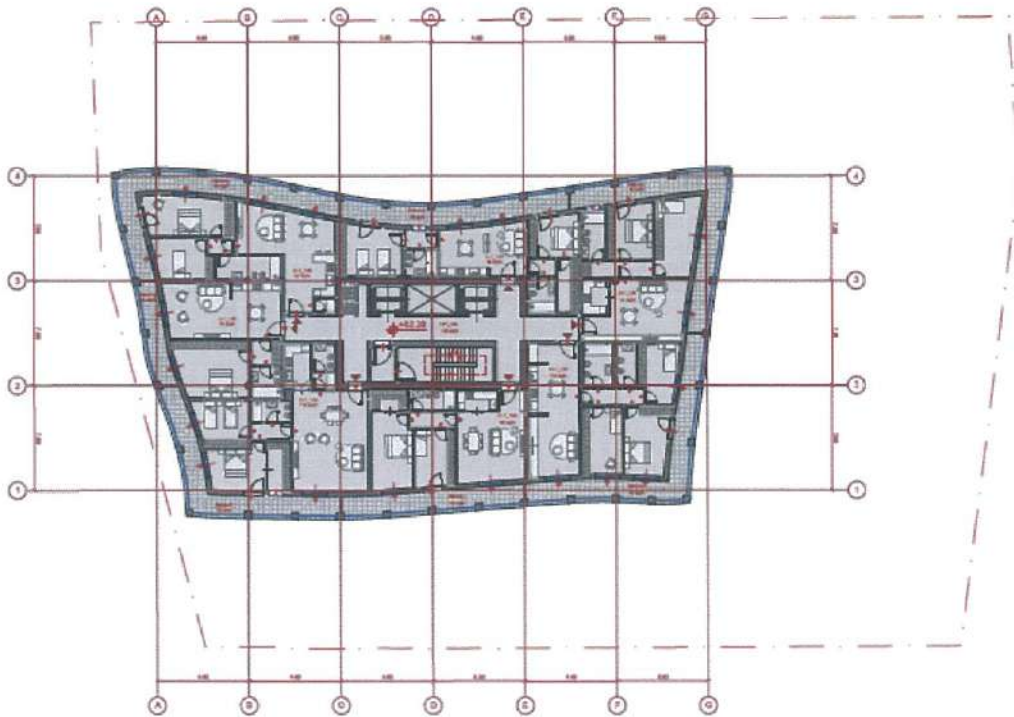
Planimetria e katit 21, në kuotën +82.28 SIP 1014 m²
